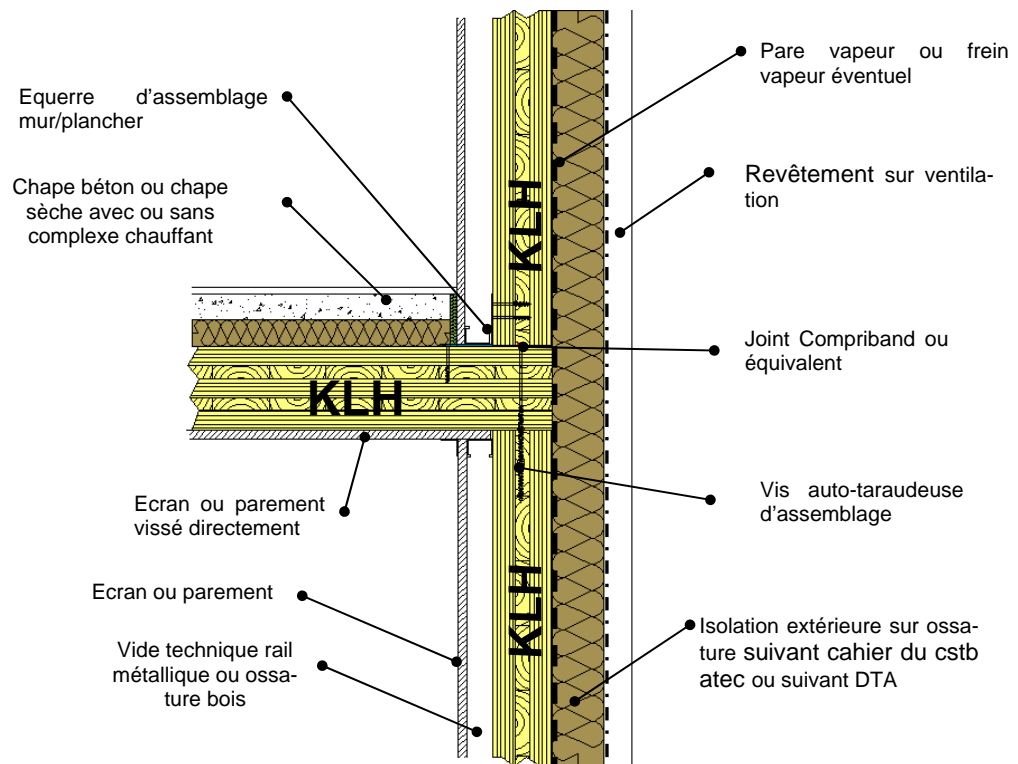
Assemblage mur/plancher locaux superposés dans un même logement
